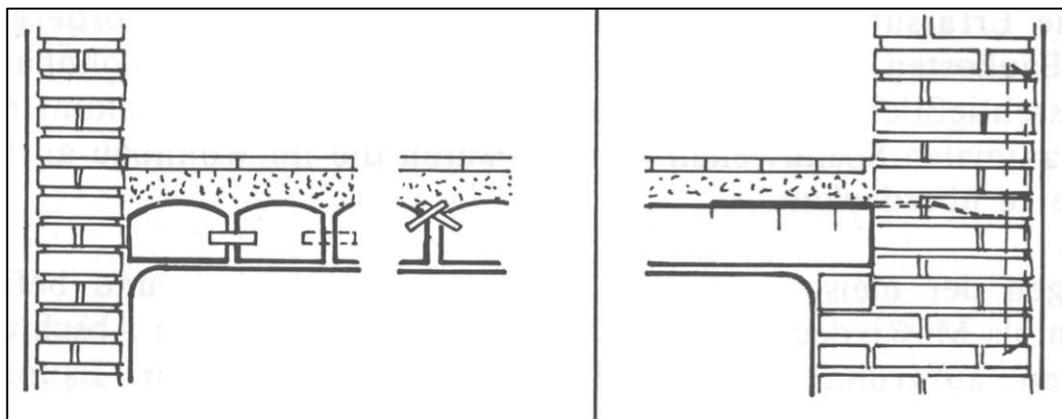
Dippelbaumdecke (links: Querschnitt – rechts: Längsschnitt) [76]
